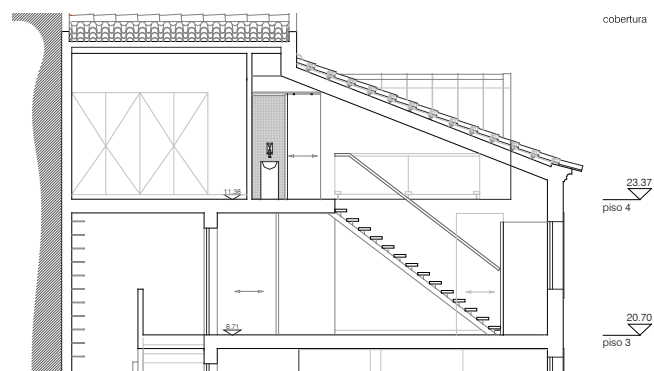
Corte CD – 3.º piso e 4.º piso (T2 duplex): Escadas metálicas para acesso ao piso superior do duplex.
